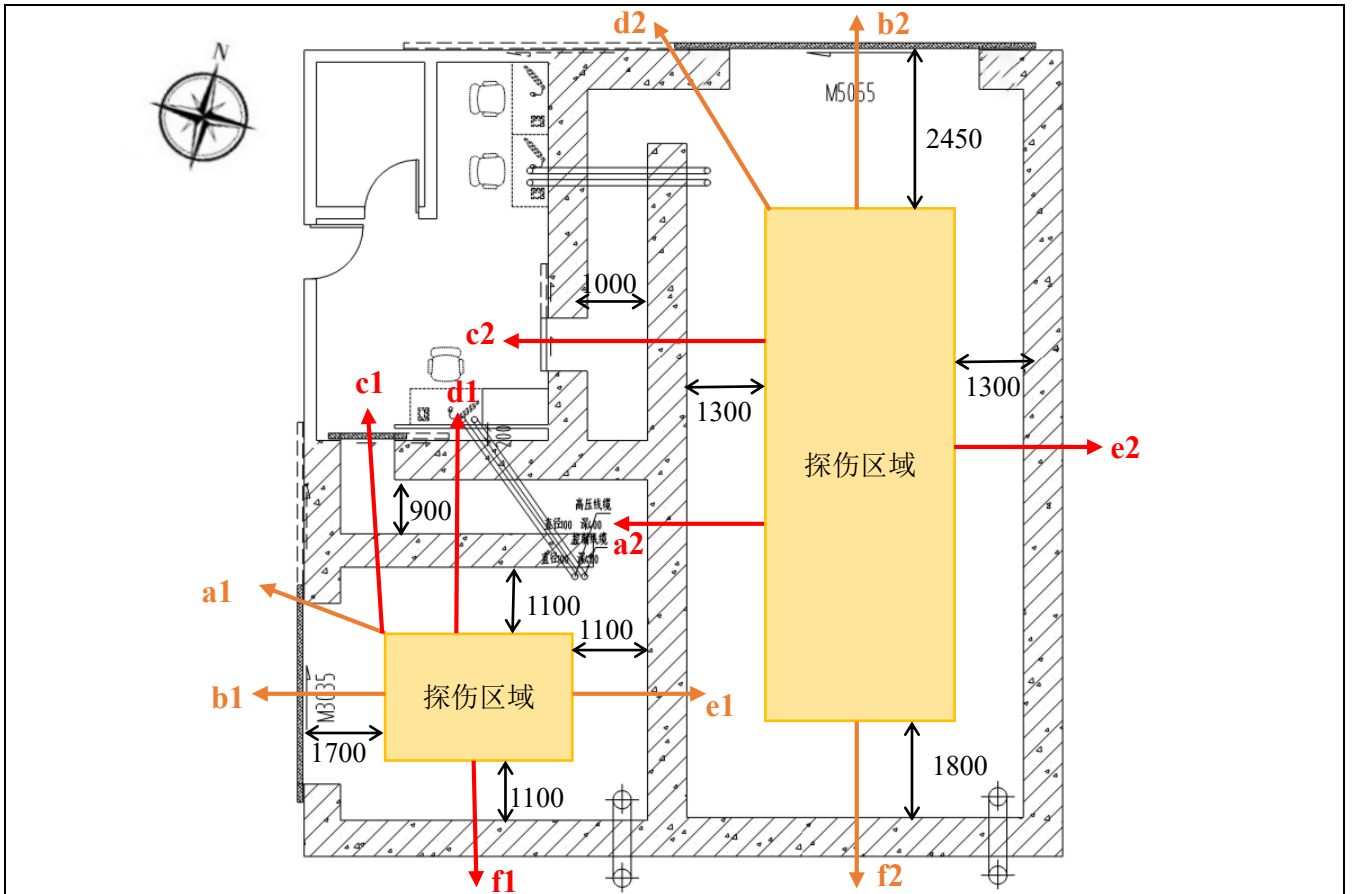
1 号、2 号探伤室辐射屏蔽计算预测点位平面图 (单位: mm)
